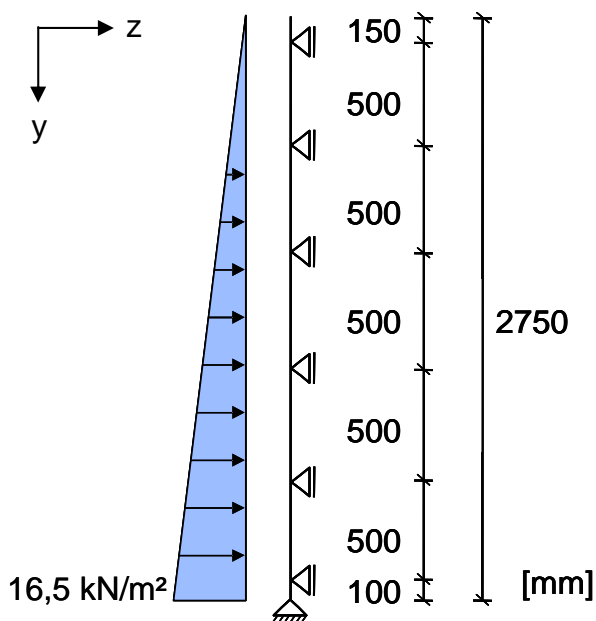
Statisches System des BIS-Elements mit Belastung aus Frischbetondruck
